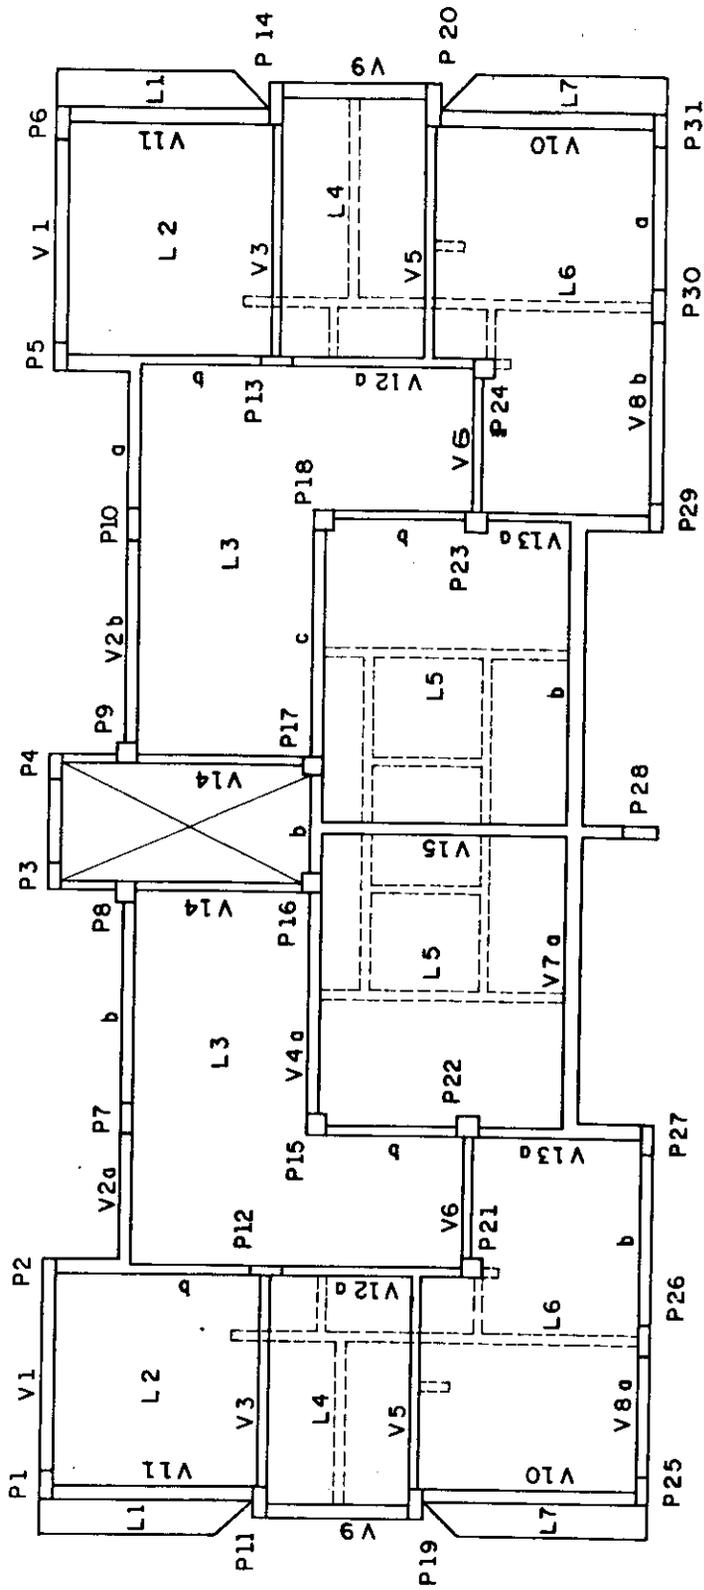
a - Estrutura III - Pavimento Tipo Edifício B
